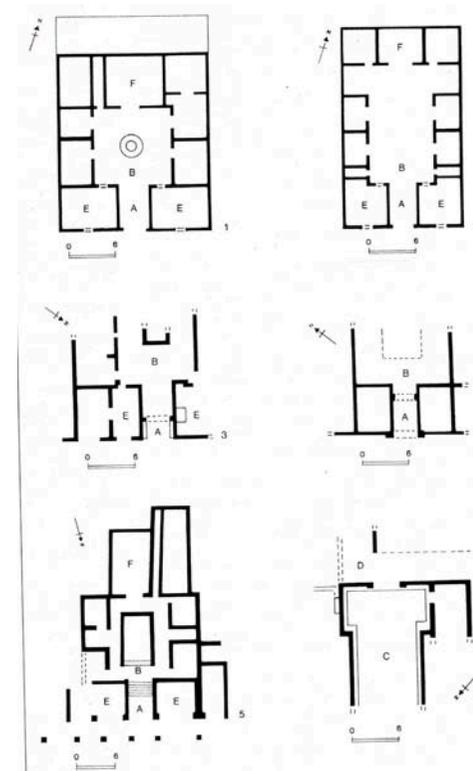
Schema planimetrico di domus con strutture di atrii e ingressi.
